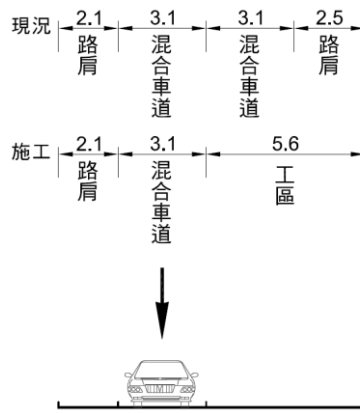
民國路 RCP 管施工斷面配置示意圖
